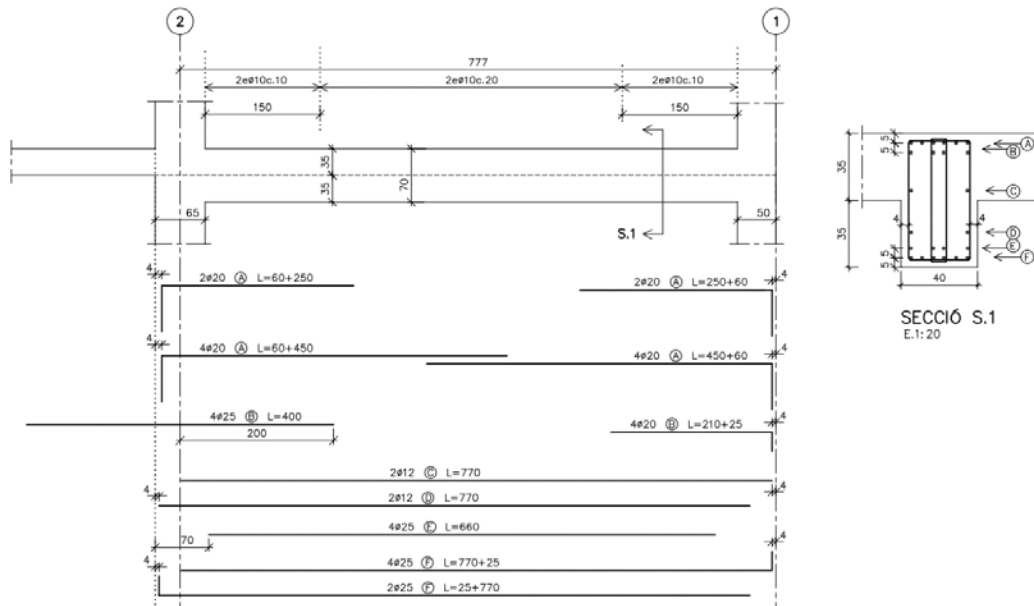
Sección longitudinal y transversal de la viga J-1 (Fuente: Planos estructurales del edificio K2M)
